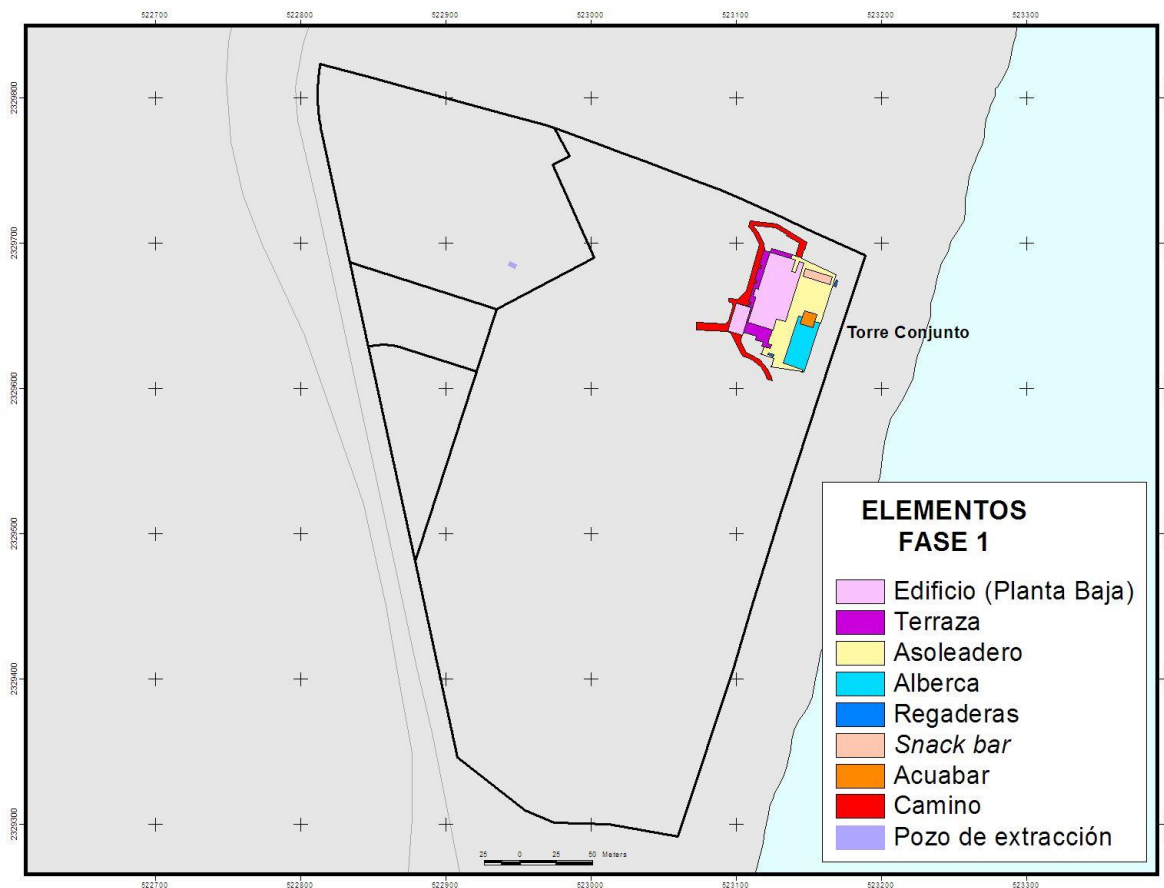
Planta arquitectónica de conjunto de la Fase 1 del Proyecto.
